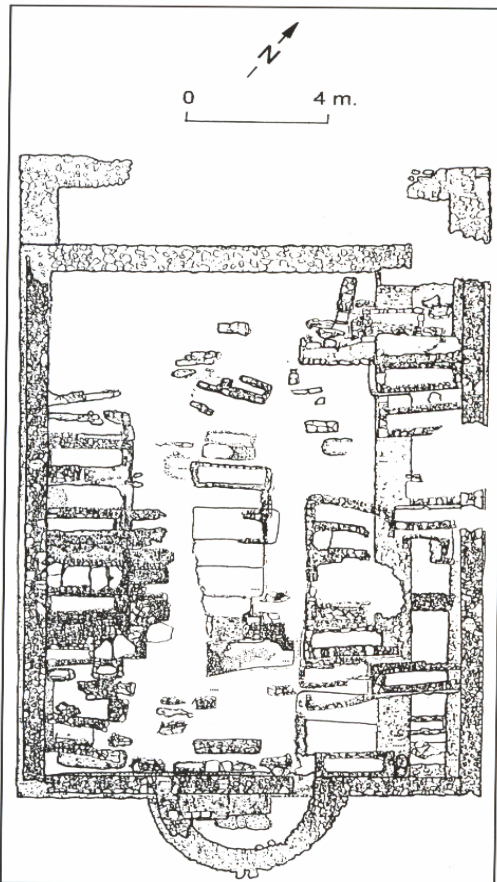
Plano del edificio cementerial de planta basilical (Fernández Sotelo 1995).
